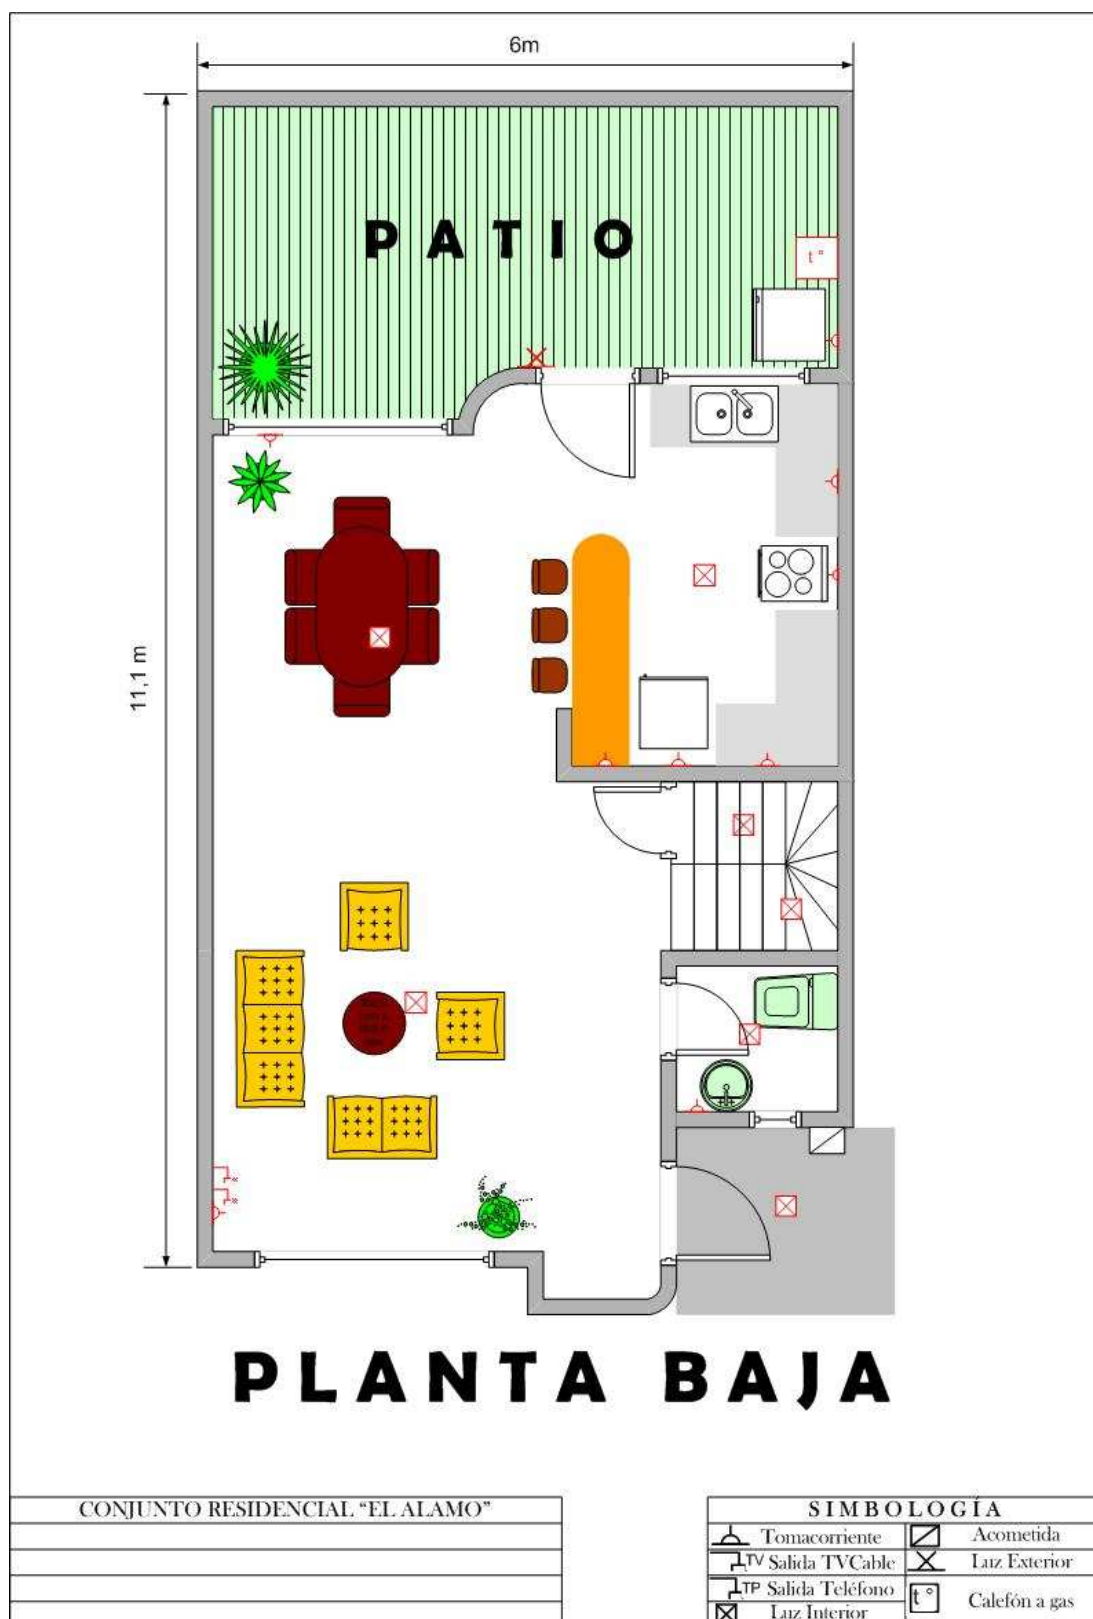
Distribución física y eléctrica de la Planta Baja
